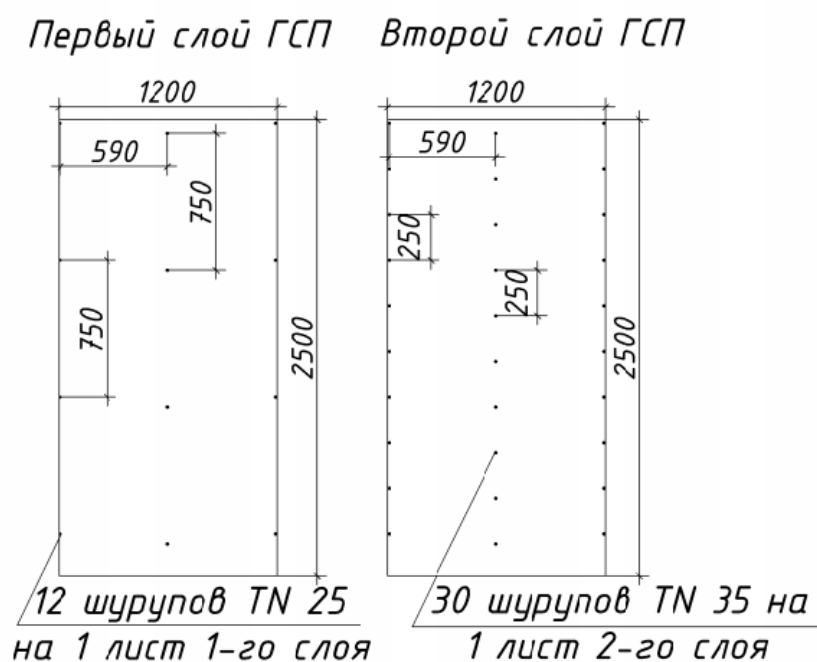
Схема расположения шурупов при двухслойной облицовке ГСП.
